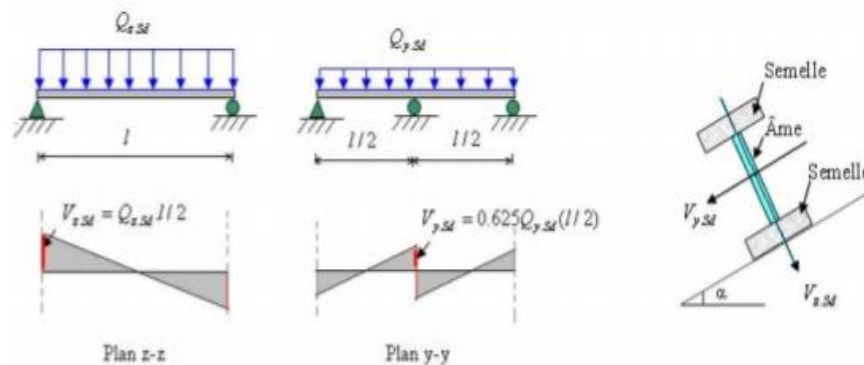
panne de toiture en cisaillement sous différents plans de chargement.
